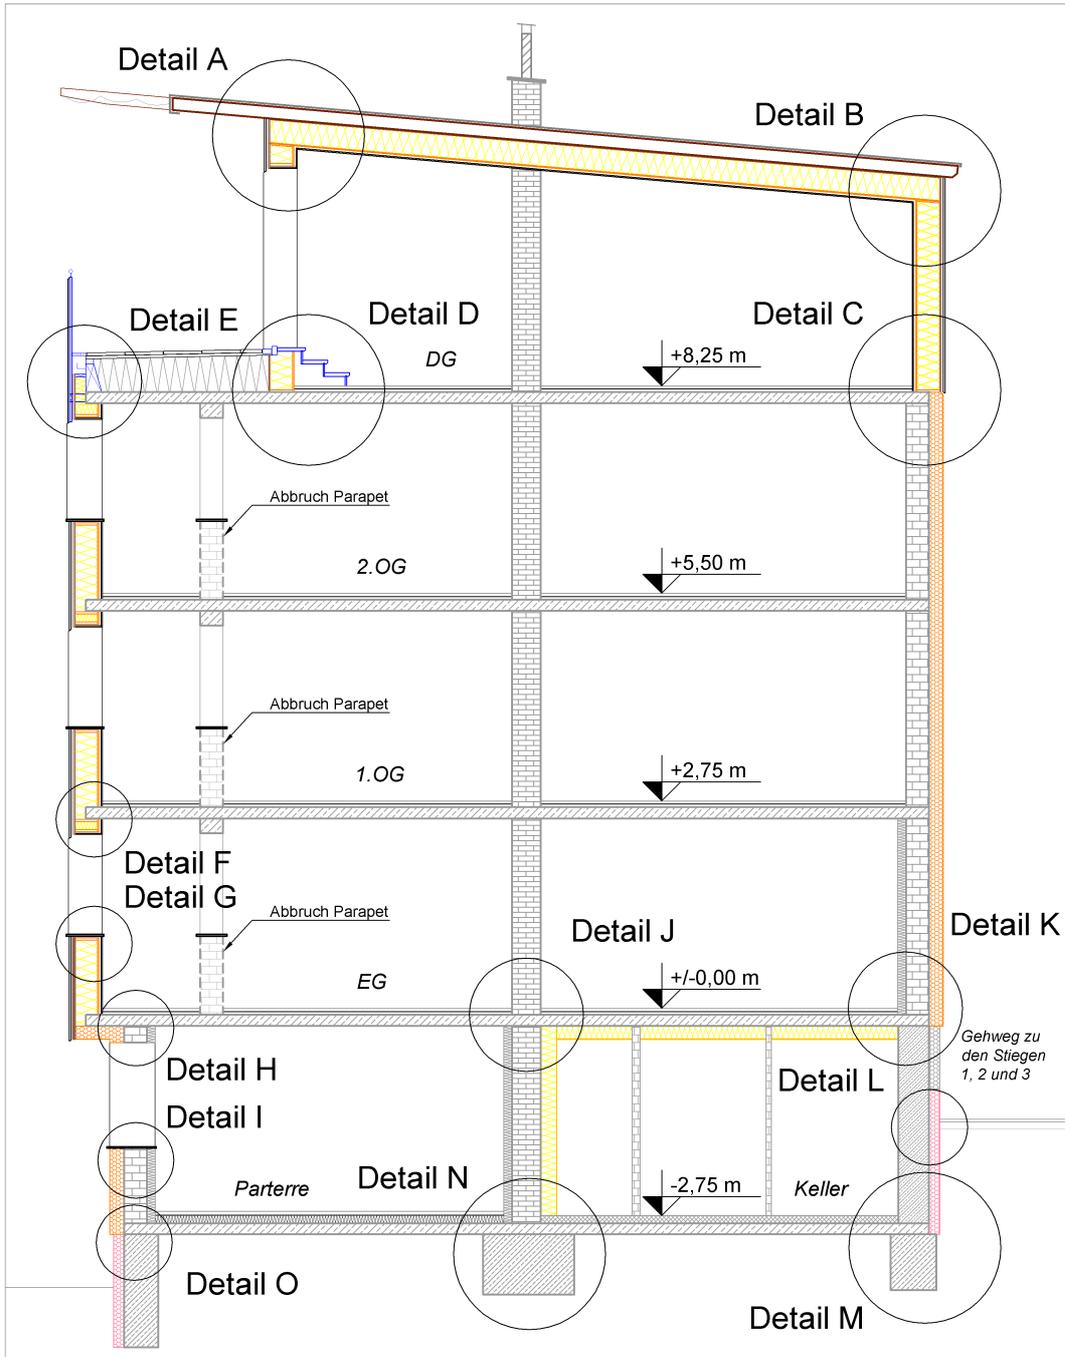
Gebäudeschnitt mit Hochbaudetails, Sanierungsvariante *Passivhaus mit Dachgeschoß*, M 1:100 (der Schnitt verläuft durch die eingehausten Loggien auf Stiege 1)
